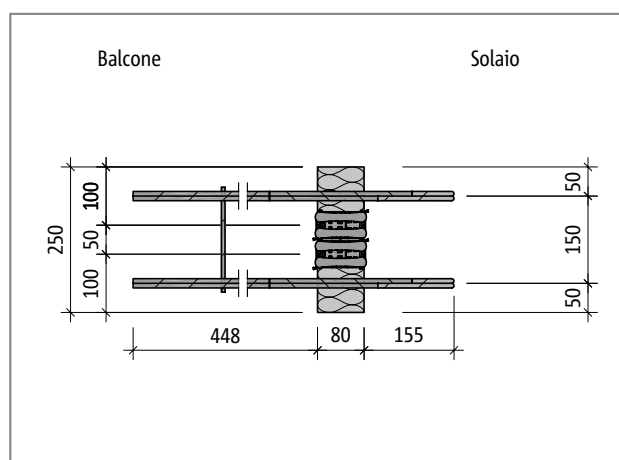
Schöck Isokorb® tipo QP10S-VV, pianta del prodotto
